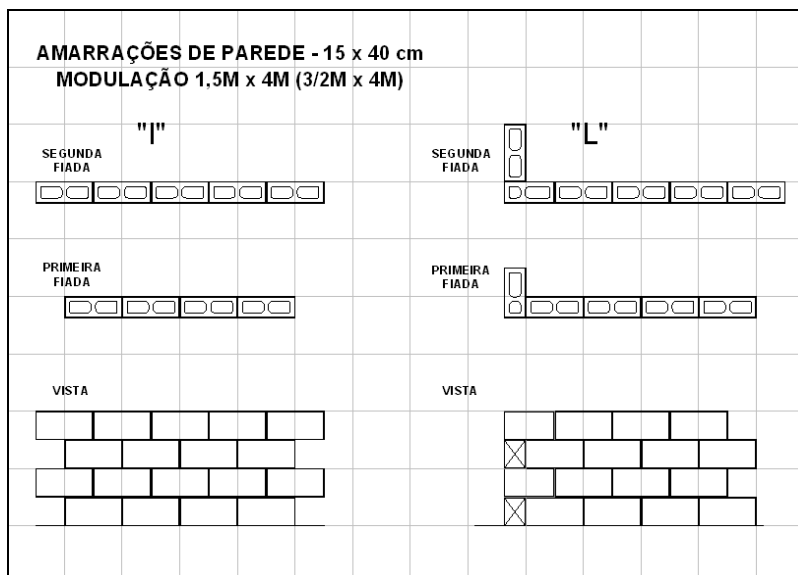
Modulação 1,5M x 4M. Amarrações de parede “I” e “L”
